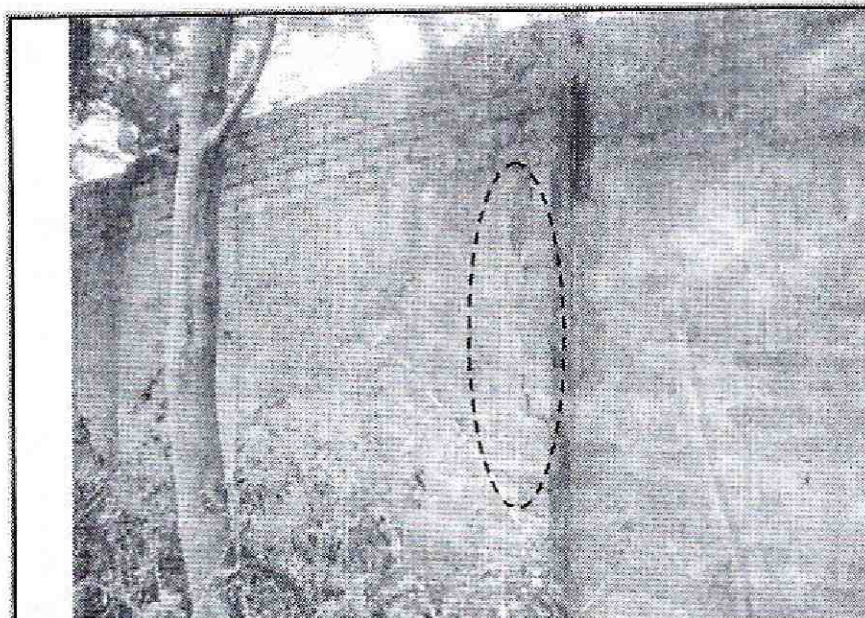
Vista de las fisuras de tendencia longitudinal evidenciadas sobre el muro evaluado en el presente informe.
